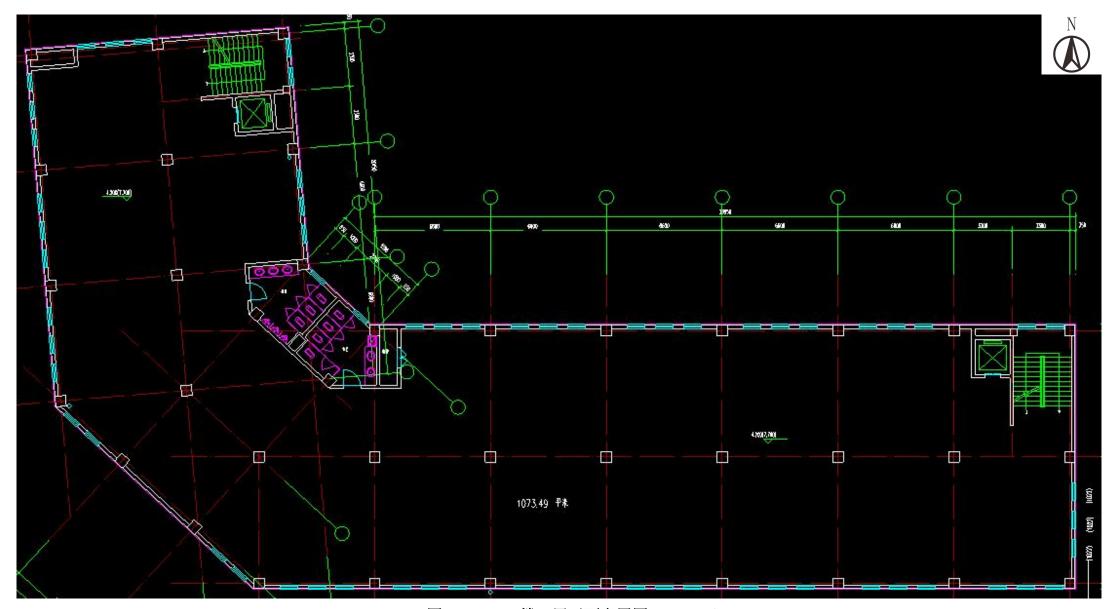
2#楼 2 层平面布置图 (1: 100)
